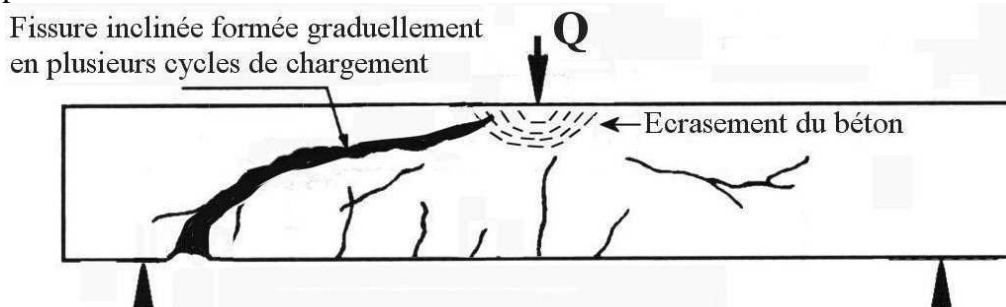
Schéma typique d'une poutre en BA endommagée par la compression due au cisaillement.
